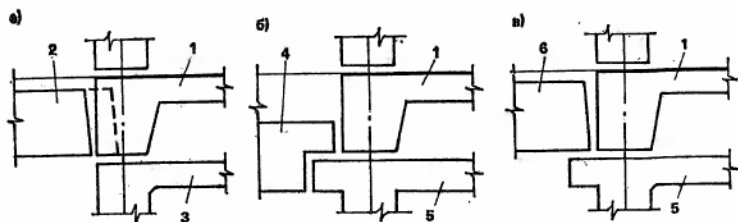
Горизонтальные стыки панельно-блочных зданий с опиранием плиты перекрытия
